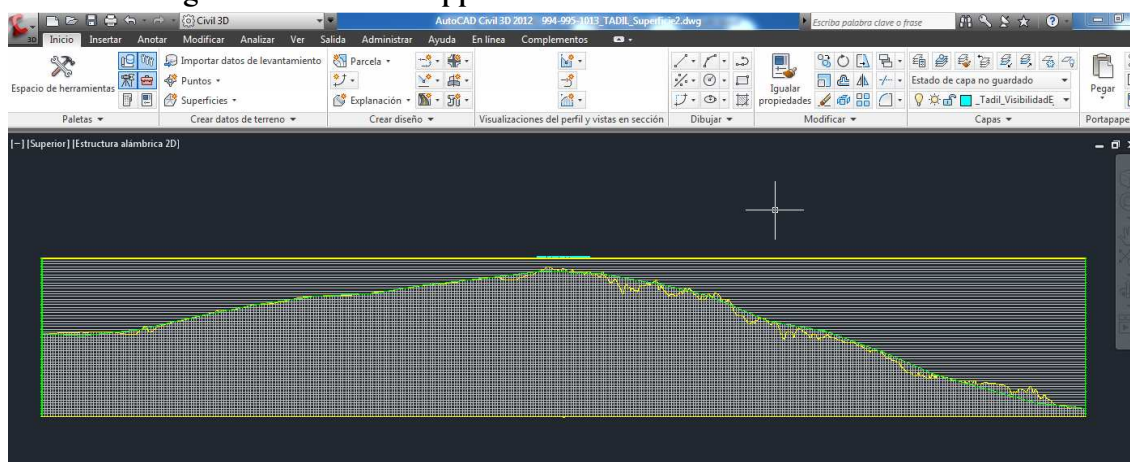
Profil longitudinal de l'enveloppe maximum avec avancées longues
